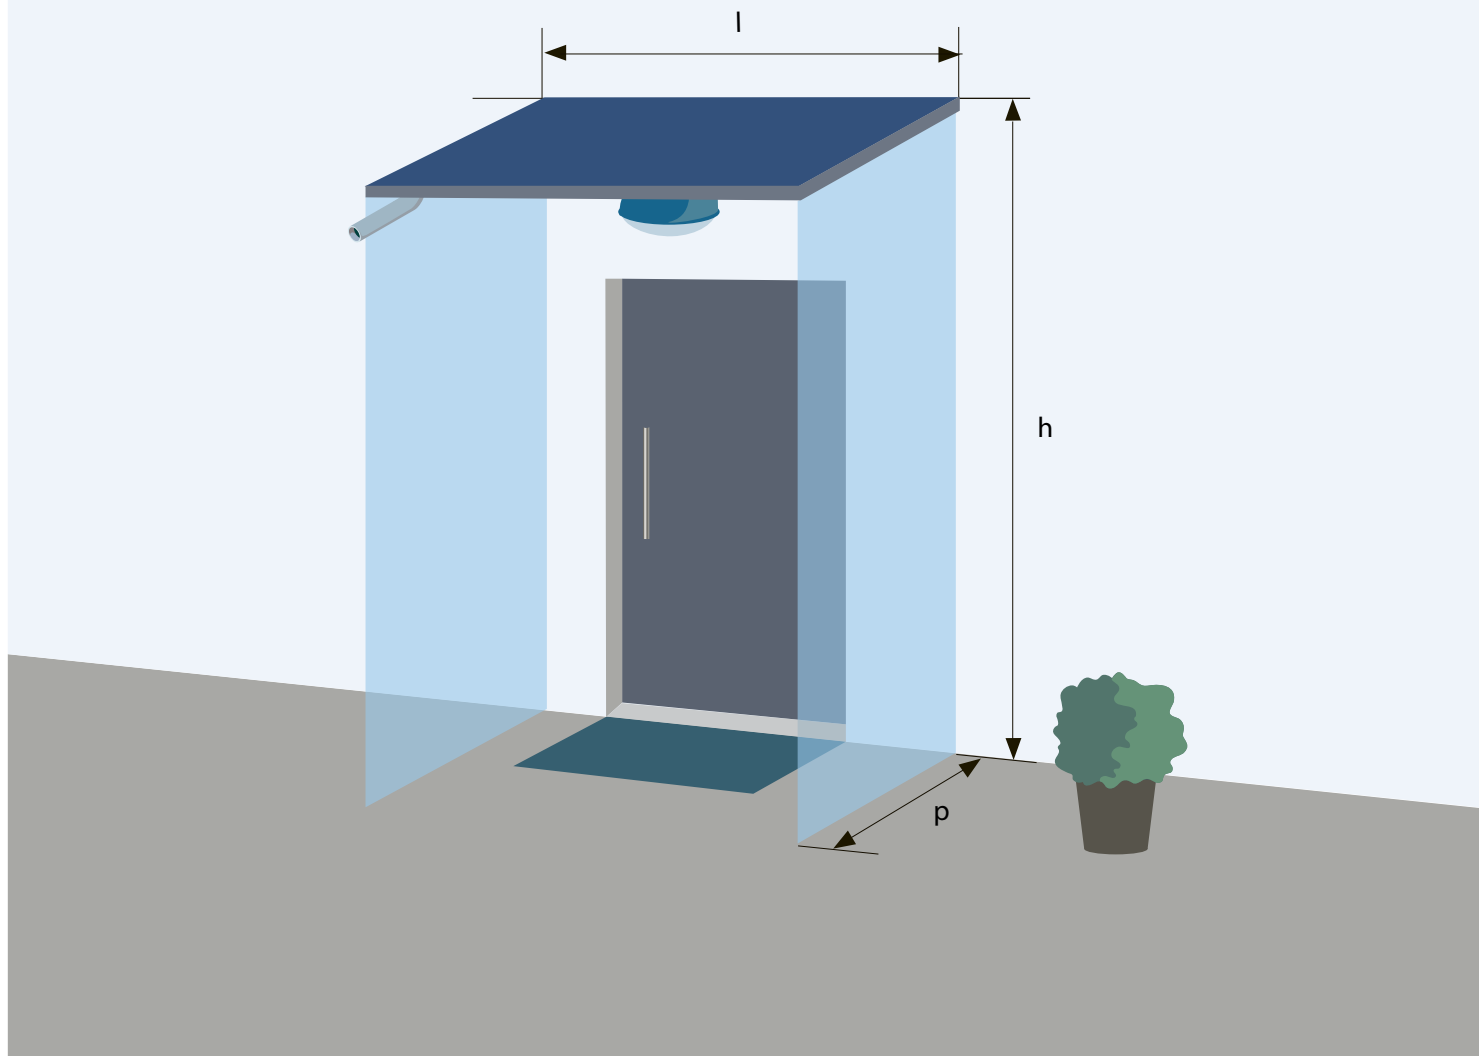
rappresentazione schematica di un sistema di protezione dalle intemperie su tre lati
